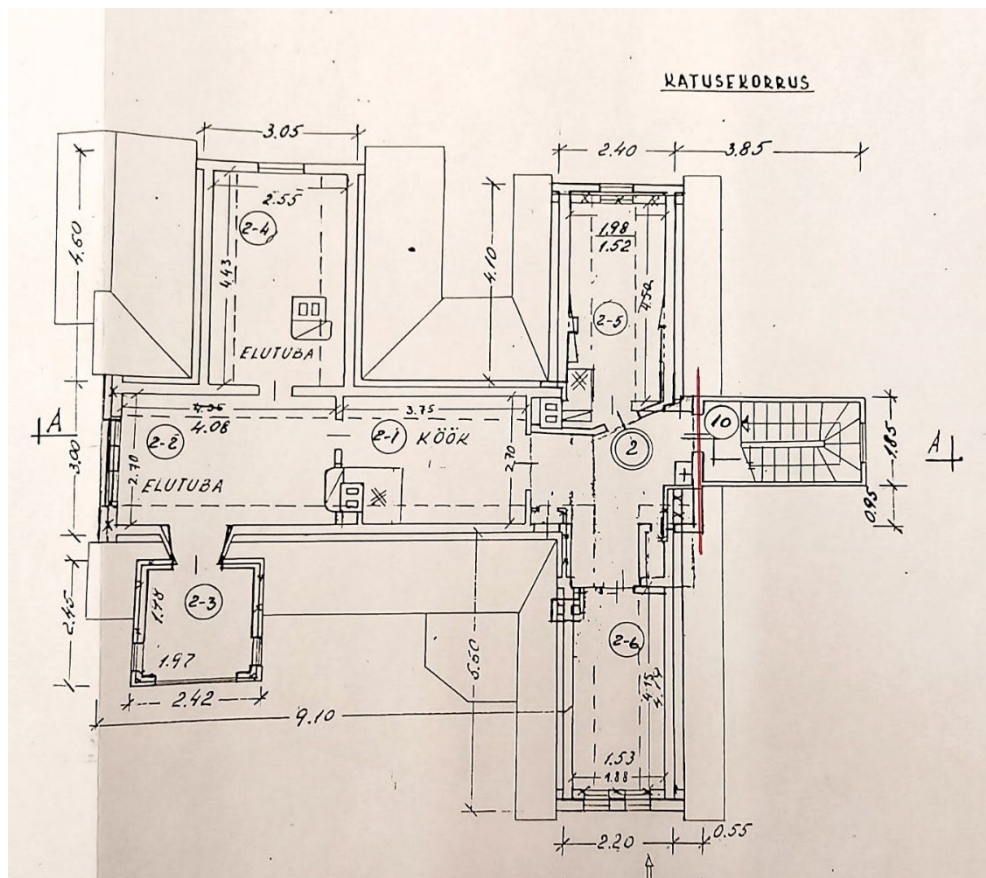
katusekorruse plaan 1947 aasta dokumentidest
